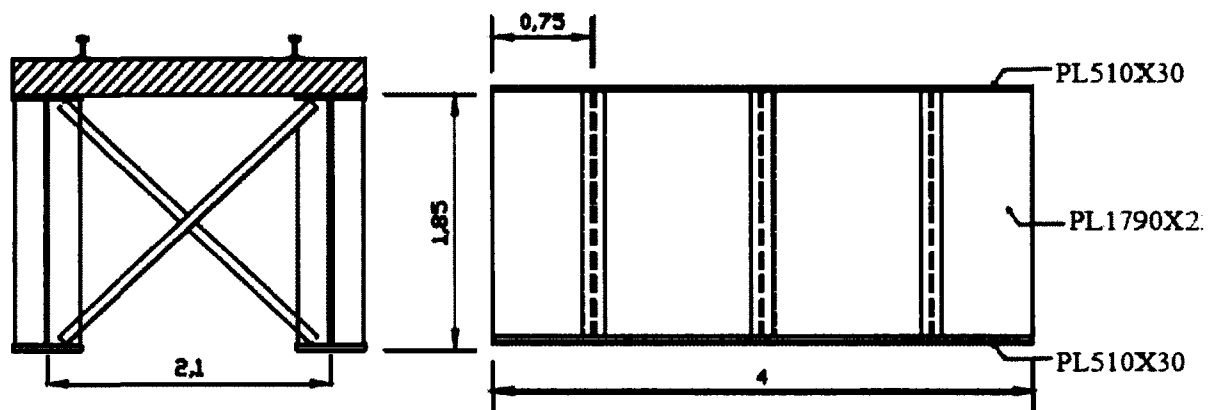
Pont bi-poutres - Section transversale et élévation - Section E-2
